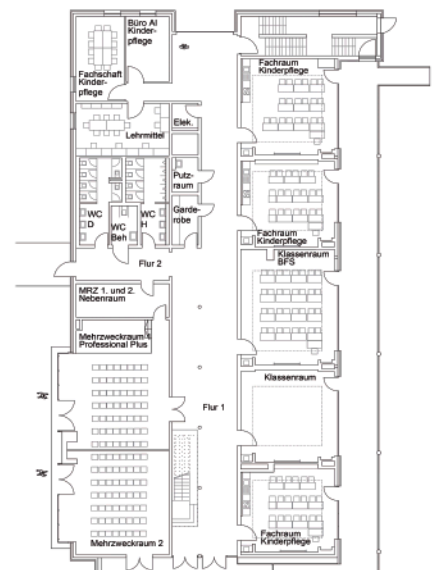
Erdgeschoss-Grundriss des 2. Bauabschnitts →
